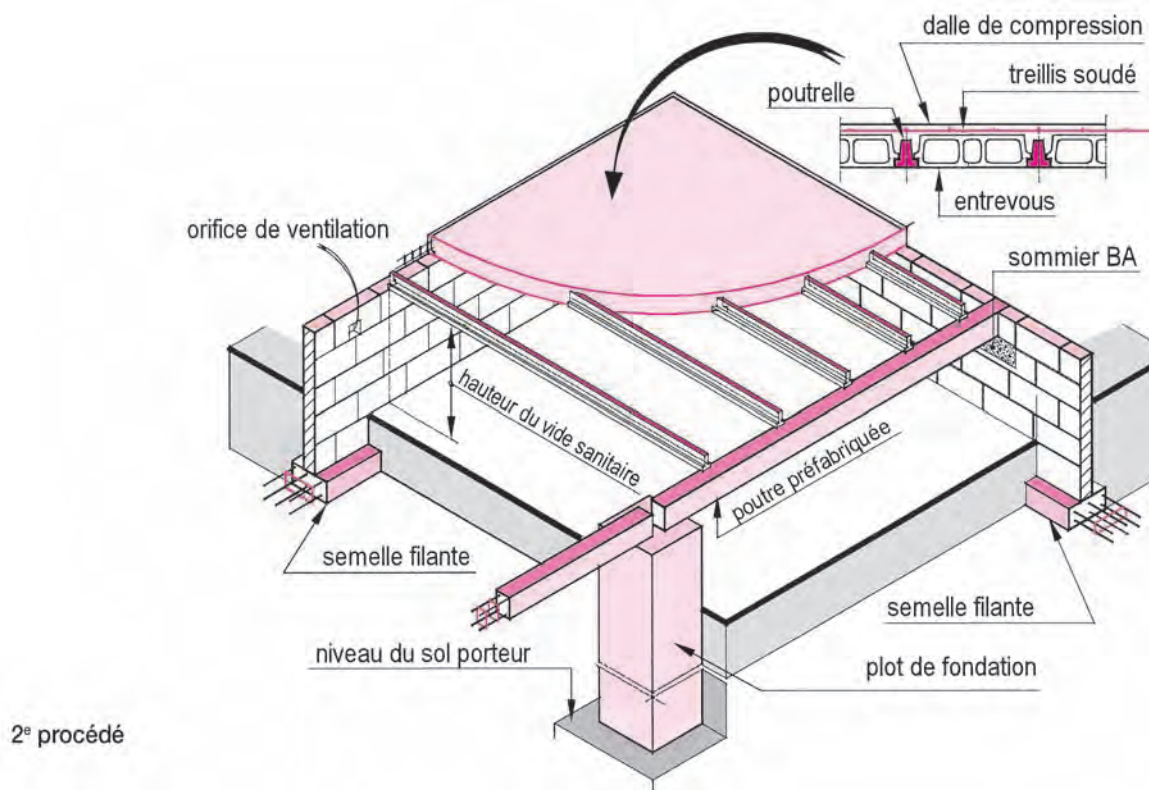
Poutres préfabriquées qui s'appuient sur les murs de rive et sur les plots
